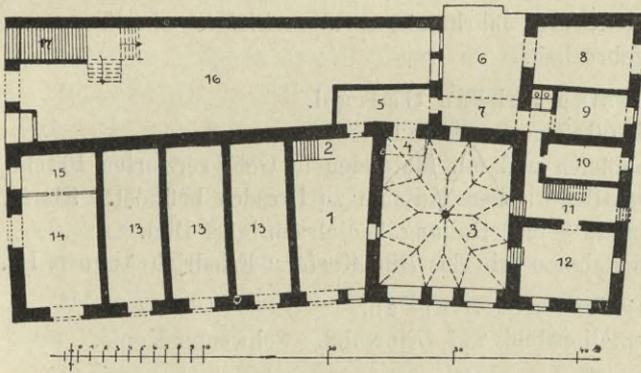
Grundriß des 1882 abgebrochenen Gewandhauses. Erdgeschoss.
